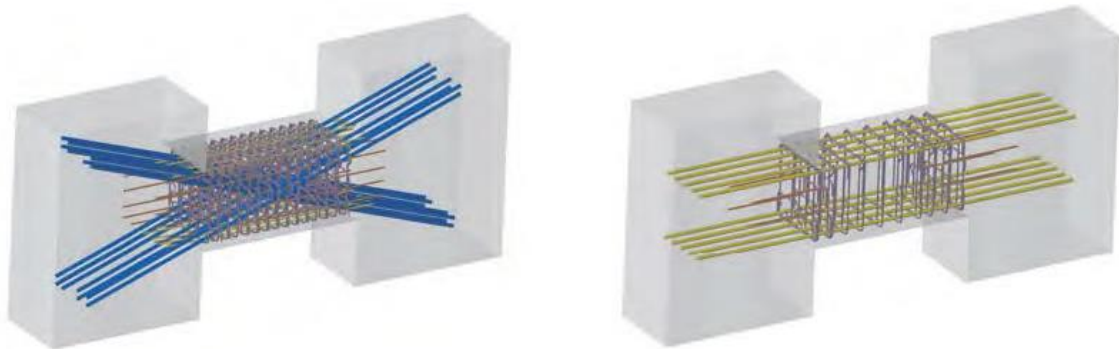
Vigas de acoplamiento reforzadas con hormigón armado (izquierda), y con HRFA y acero de refuerzo (derecha). (Kopczynski & Whiteley, 2016)
